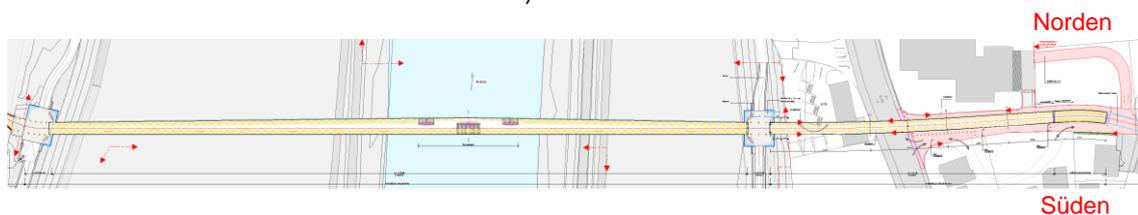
Langsamverkehrsverbindung: Beleuchtungskonzept Grundriss
